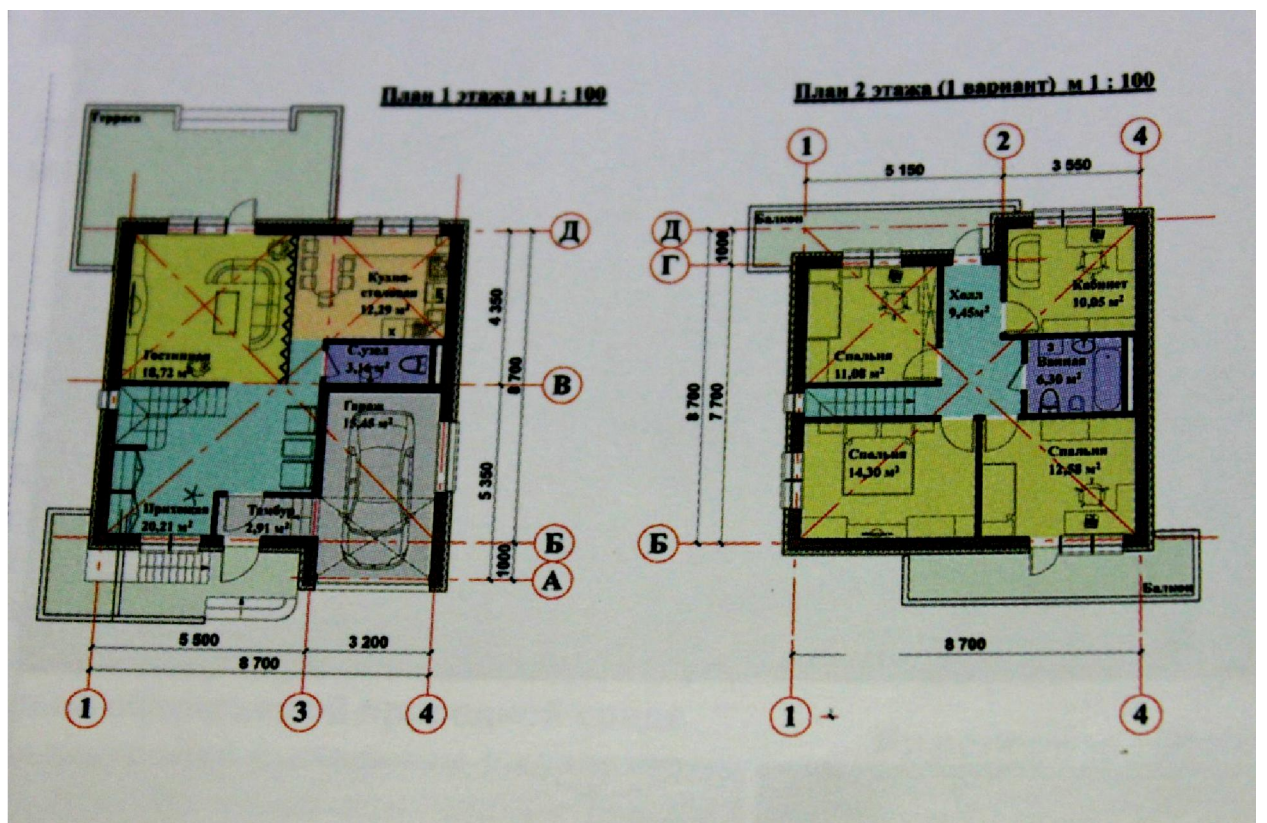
План 1-ого и 2-ого (1-ый вариант) этажей индивидуального дома
